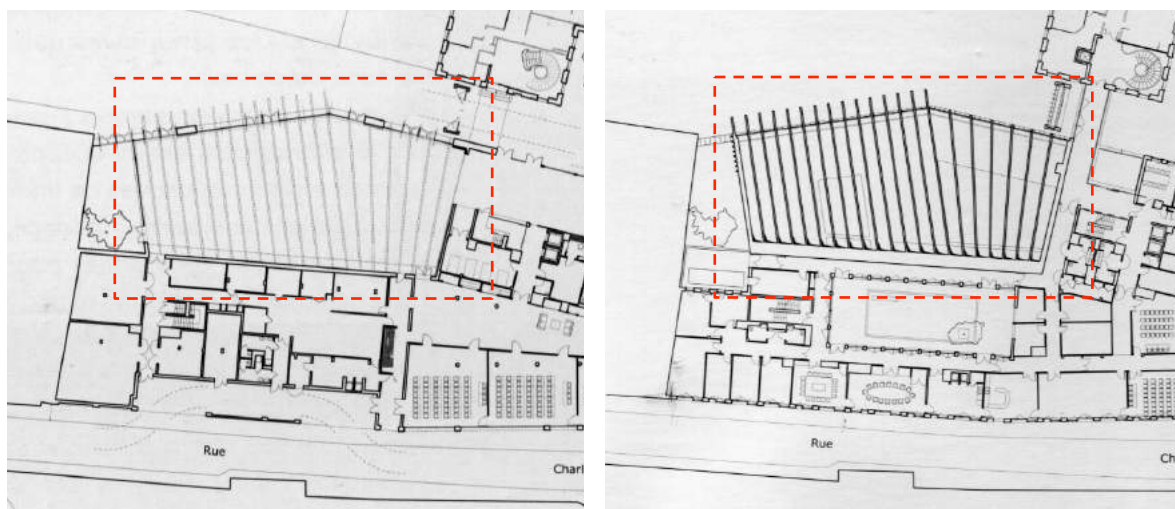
Piante del piano terra e del primo livello / Ground and first floor plans
